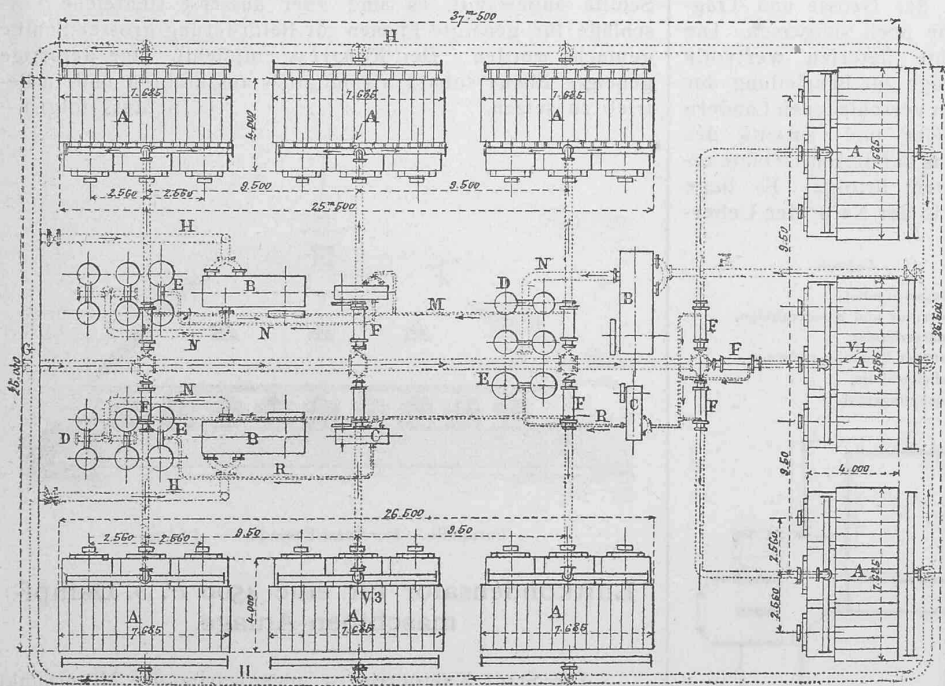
Grundriss der Luft-Kondensator-Anlage in Kalgoorlie. — Masstab 1:300.
